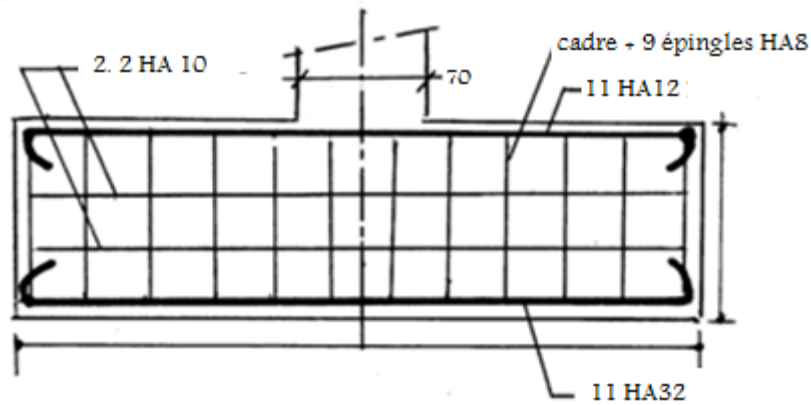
Coupe longitudinale du ferrailage de la semelle.
